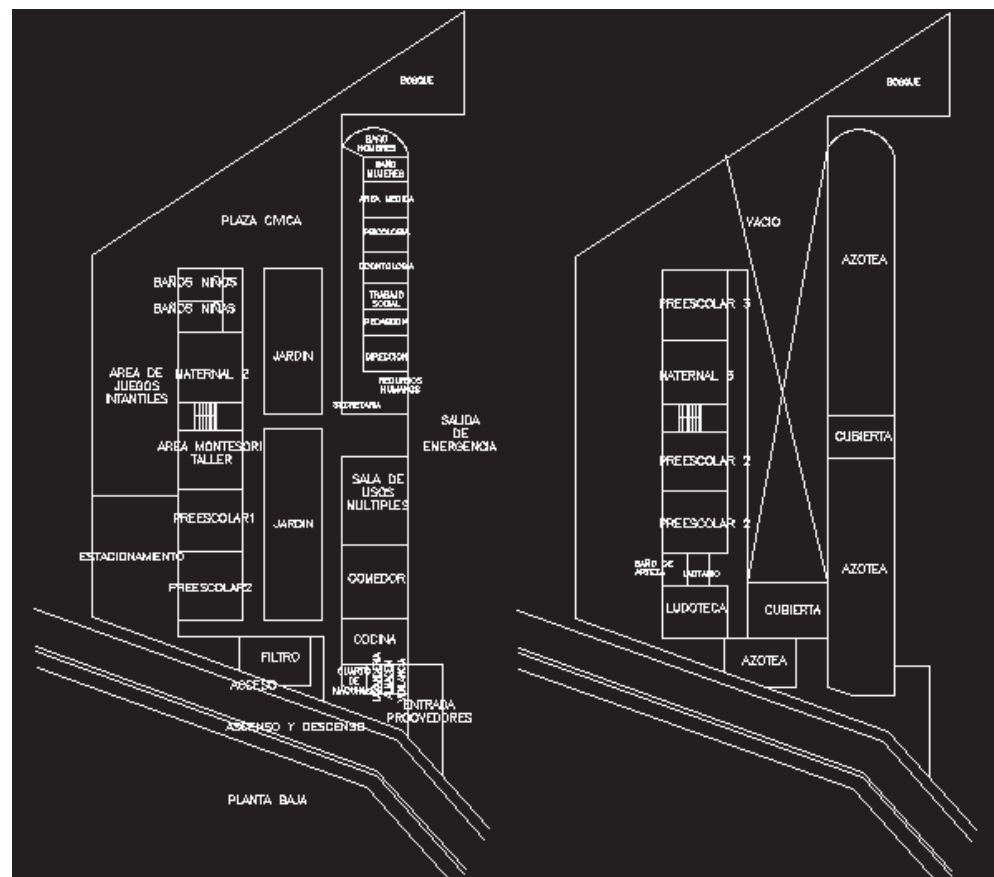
Croquis de las plantas baja y alta del CADI Lomas de las Canteras
